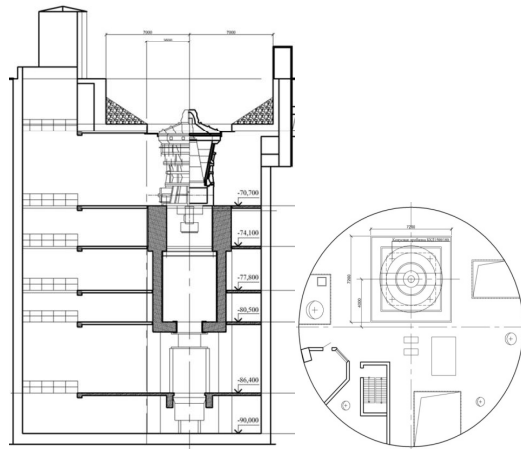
Вертикальный разрез и план отм. -70,7 м
